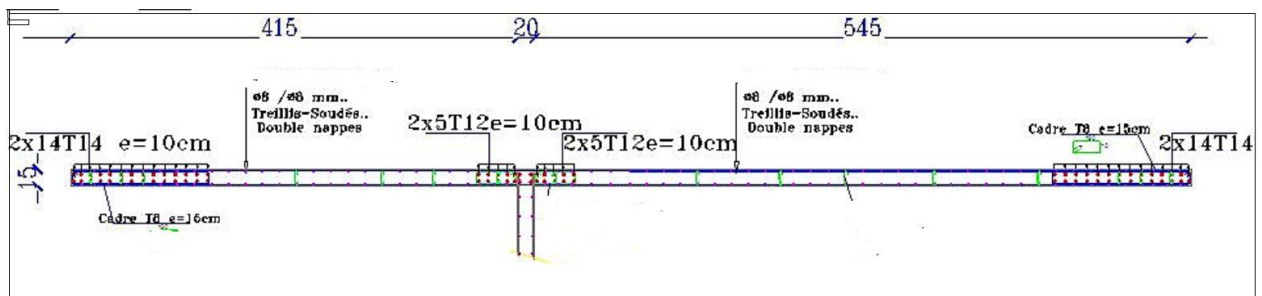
Ferrillage des voiles ue en plan VY(14, 29,1 , 13).
